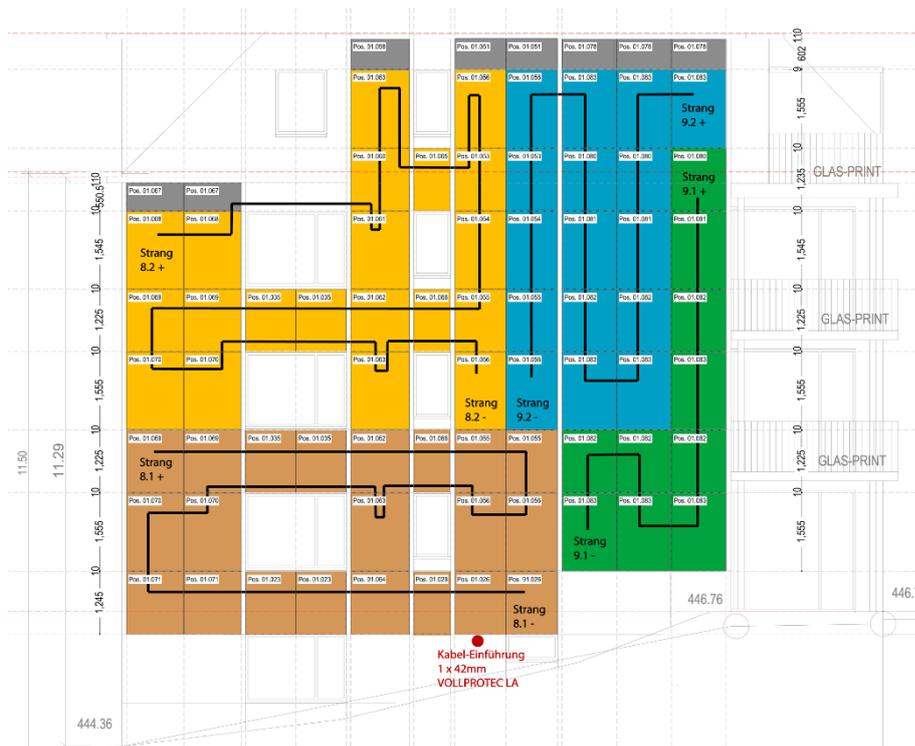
Stangplan Fassade Oberwiesenstrasse West
